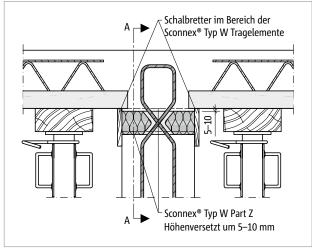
Schöck Sconnex® Typ W: Schematische Darstellung (Einbauzustand) Schöck Sconnex® Typ W bei Halbfertigteildecken und Unterdeckendämmung
